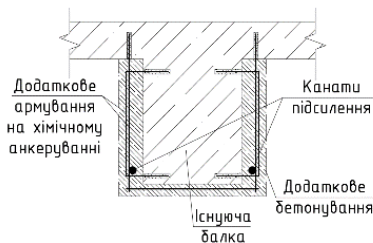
Нерозрізна балка, підсилена за допомогою напружених канатів з подальшим обетонуванням («Reinforcing internal post-tensioning»)
